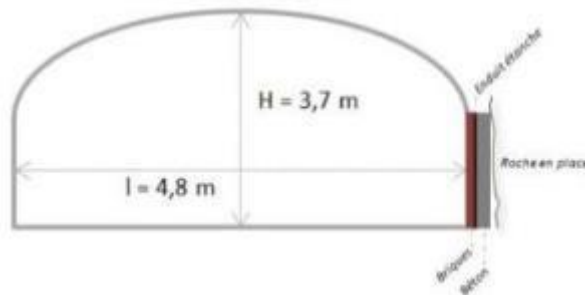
Coupe schématique d'une galerie principale et détail sur sa conception
